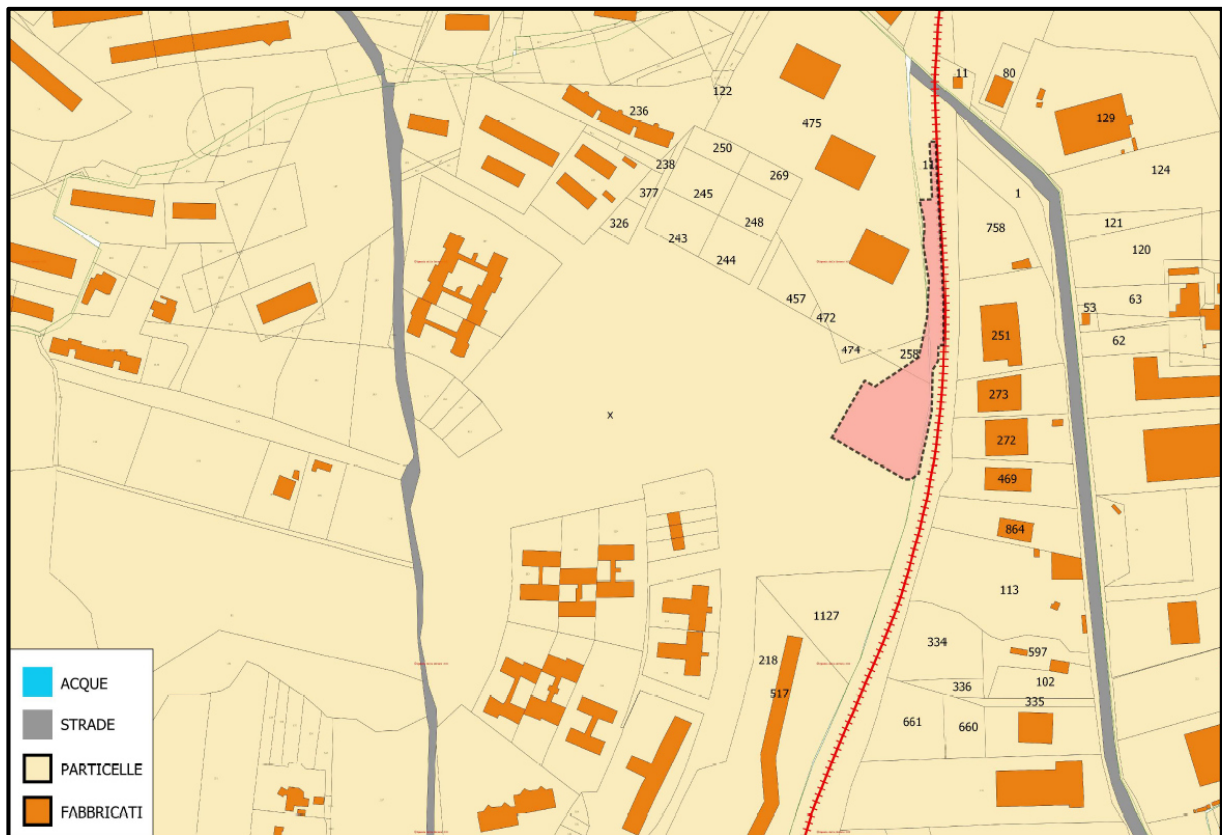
Stralcio elaborato IN01 – Planimetria di Inquadramento Urbanistico e Analisi dei Vincoli - Perimetrazione dell'area di intervento su planimetria catastale
